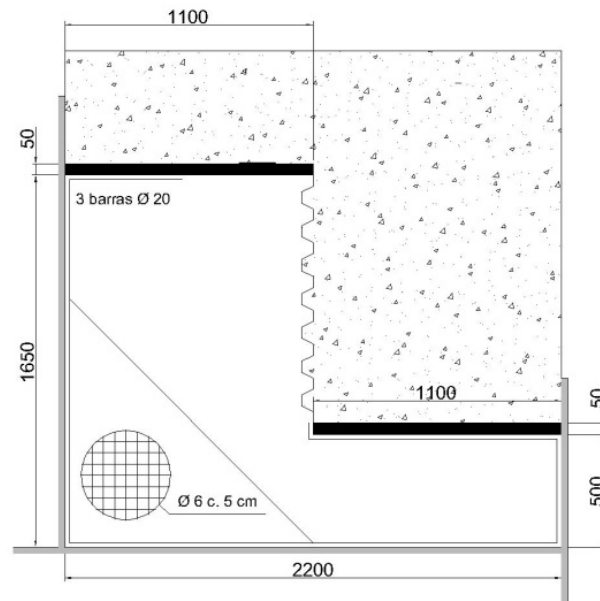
Encofrado y disposición de las barras y mallas electrosoldadas para la fabricación de la segunda pieza de hormigón para la junta de siete llaves (cotas en mm)
